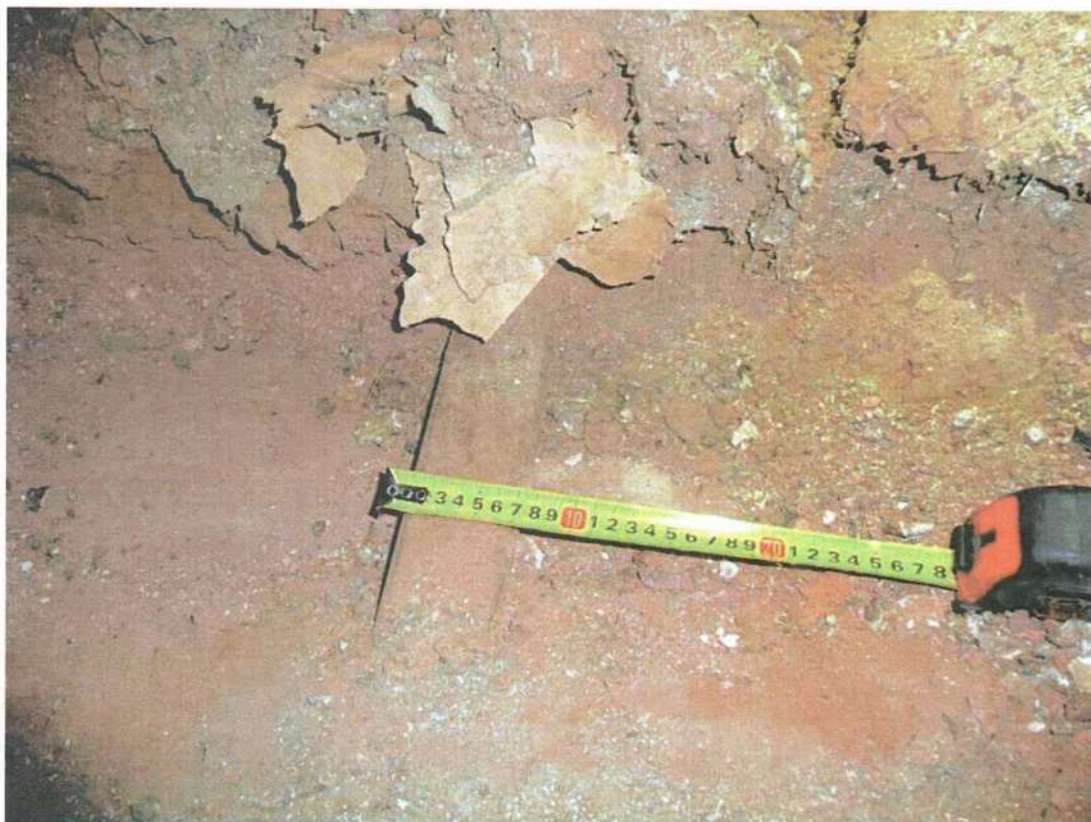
Вскрытие №1 перекрытия 2-го этажа.
